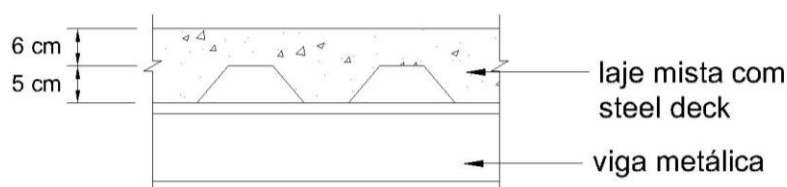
Seção transversal da viga mista utilizando laje mista (Autora (2017))
